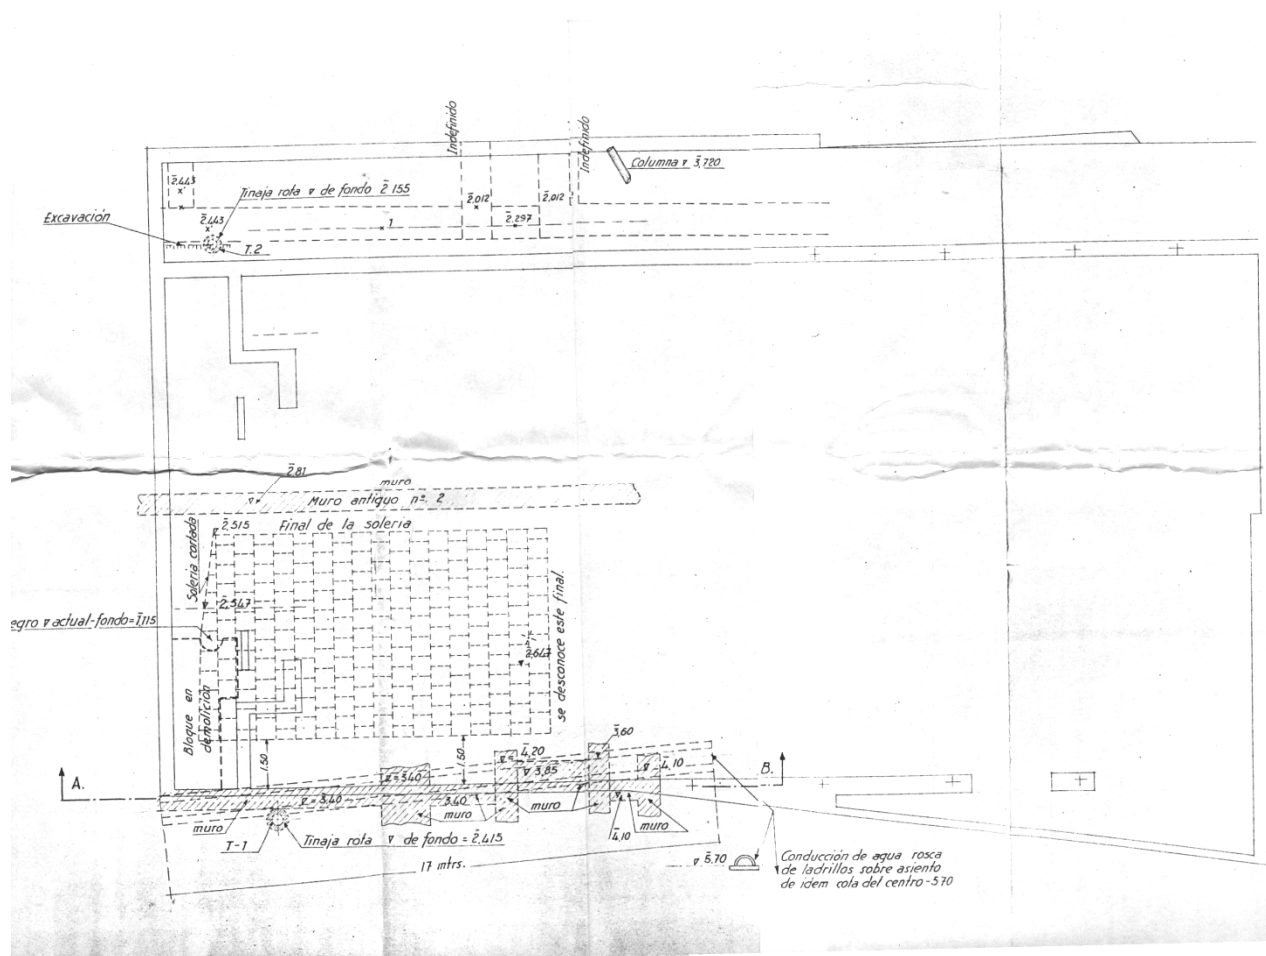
Planta de los hallazgos del Cine Imperial (Fondo *Papeles de Collantes de Terán*).
